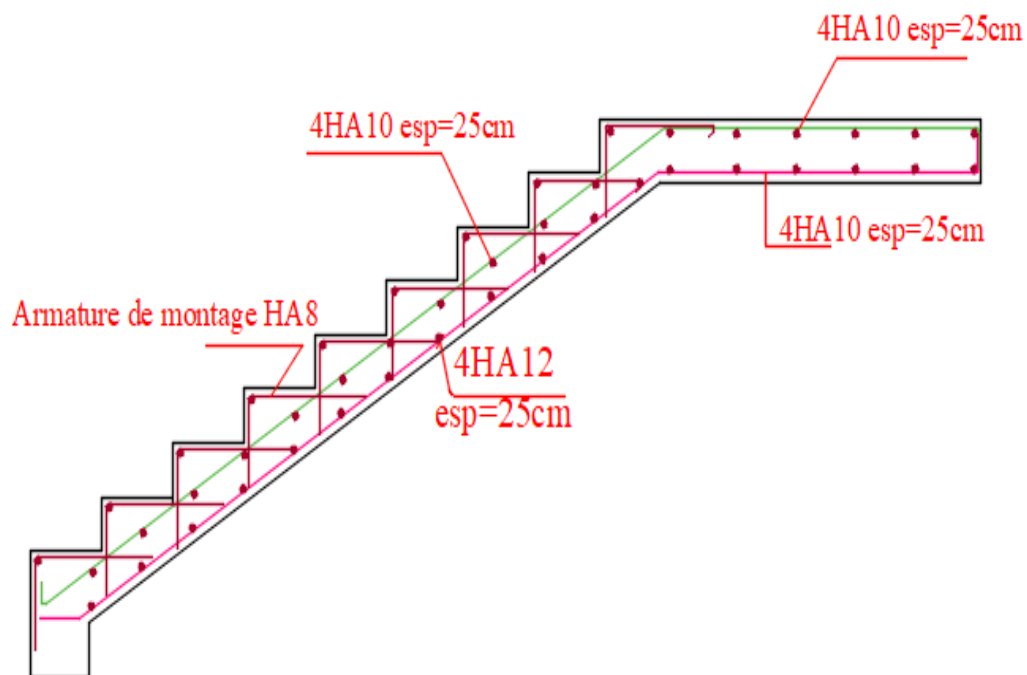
Schéma de ferrailage de l'escalier.
